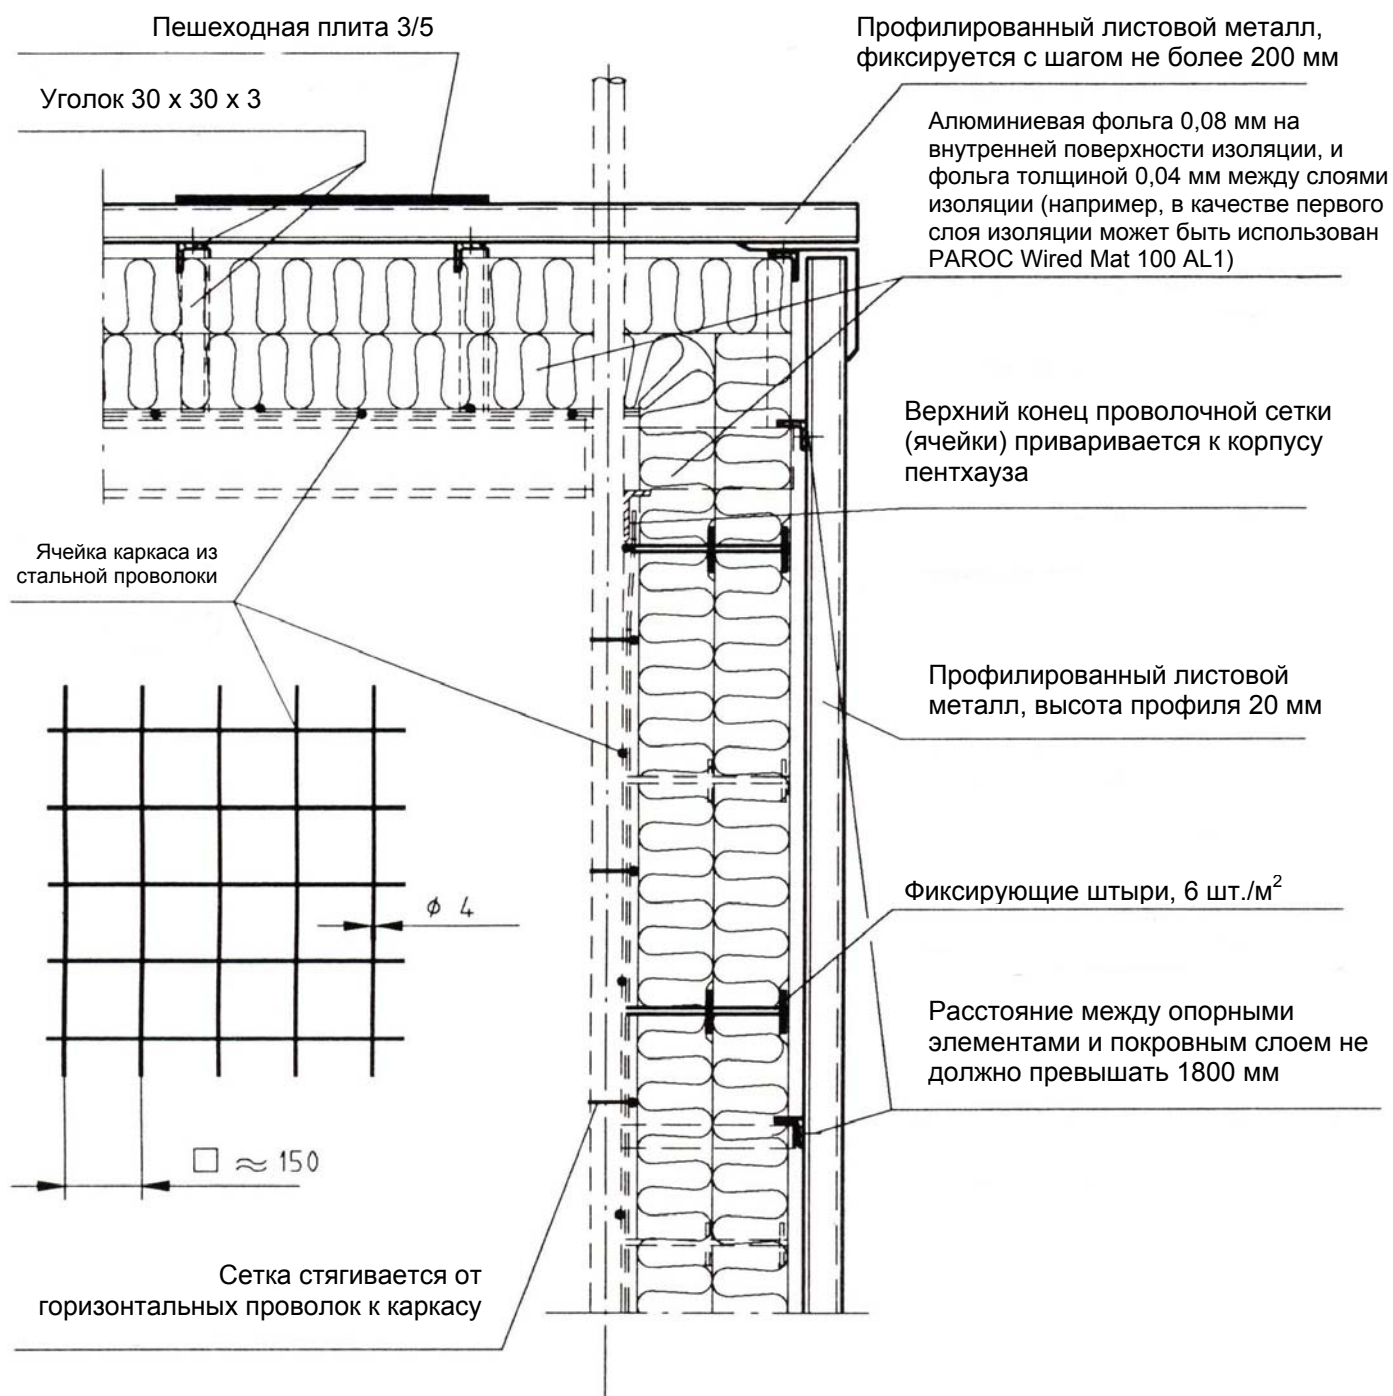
Каркас и изоляция для крыши и стен пентхауза (теплого ящика) котла
